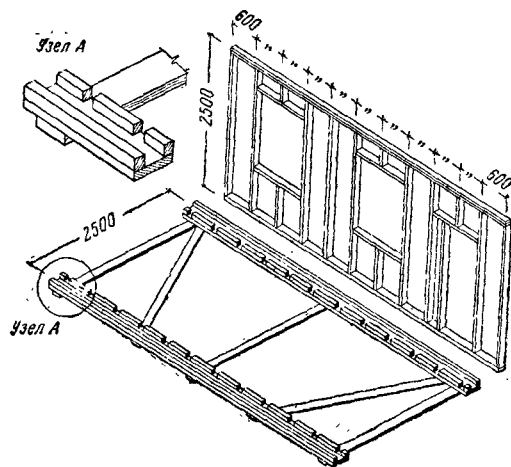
Рама каркасной стены и шаблон для ее изготовления
